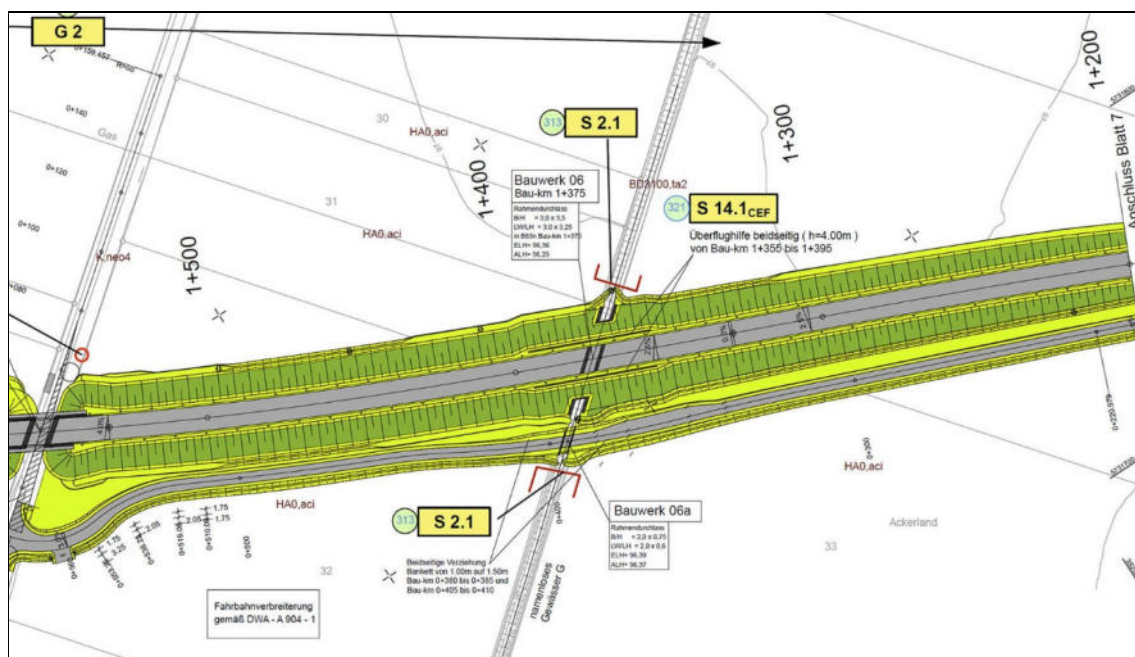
Ausschnitt aus dem Maßnahmenlageplan des LBP zu Struktur 3
